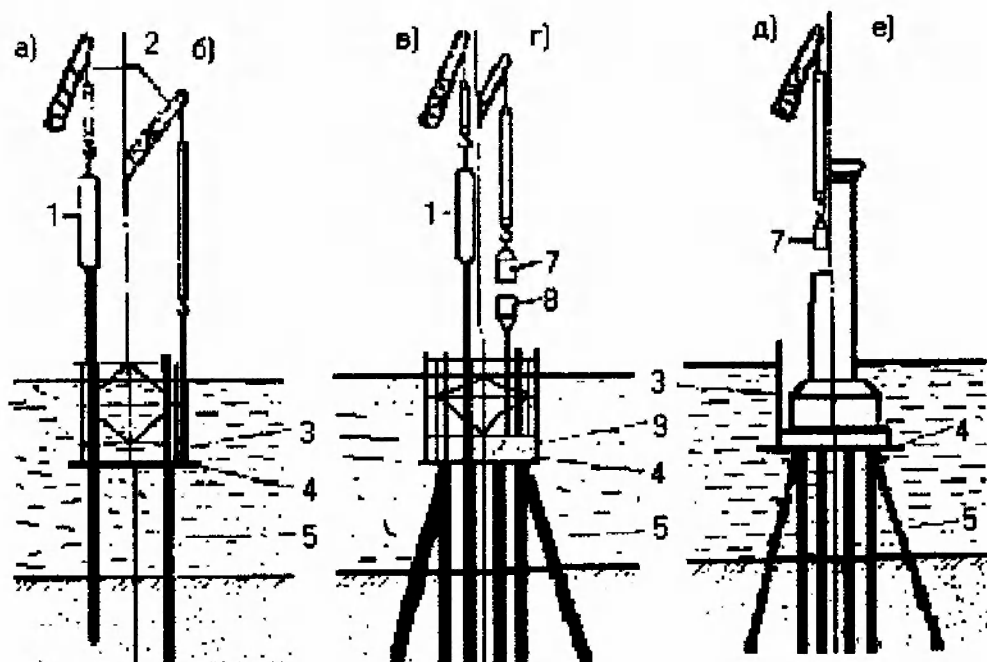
Последовательность работ при сооружении свайного фундамента с ростверком, расположенным под грунтом:
